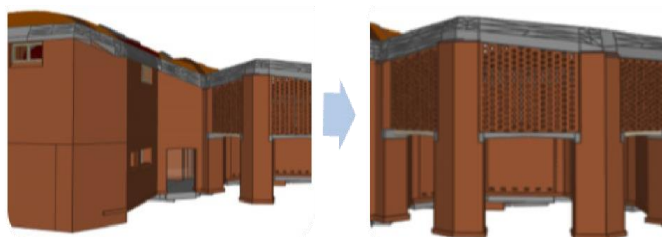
Creación de pilares arquitectónicos y estructurales. Fuente: elaborada por la autora.
